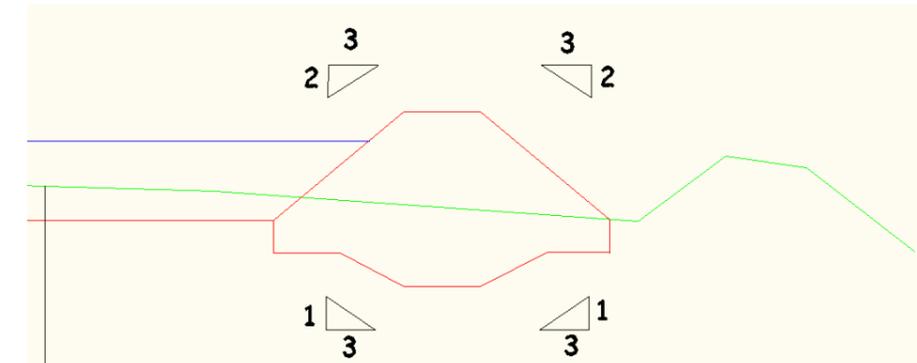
Coupe schématique du principe d'ancrage de l'ouvrage Aval au 5/2, échelle modifiée (coupe BB')
